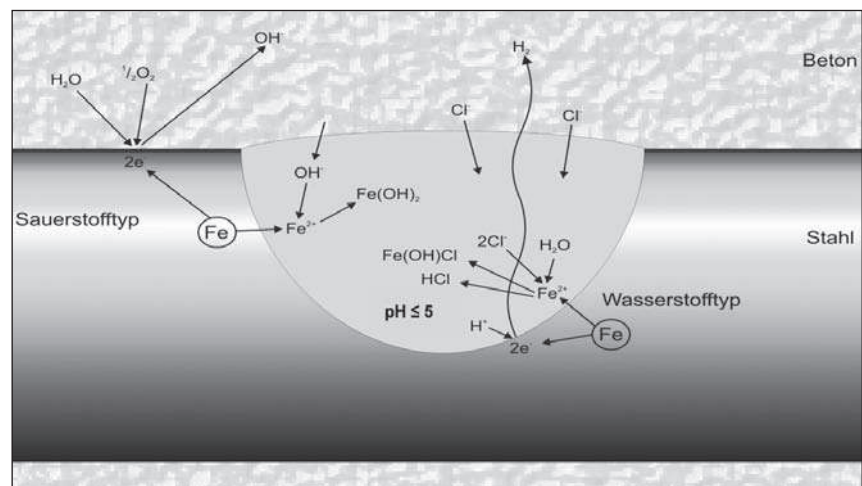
Schadensmechanismus der chloridinduzierten Lochkorrosion von Stahl in Beton
